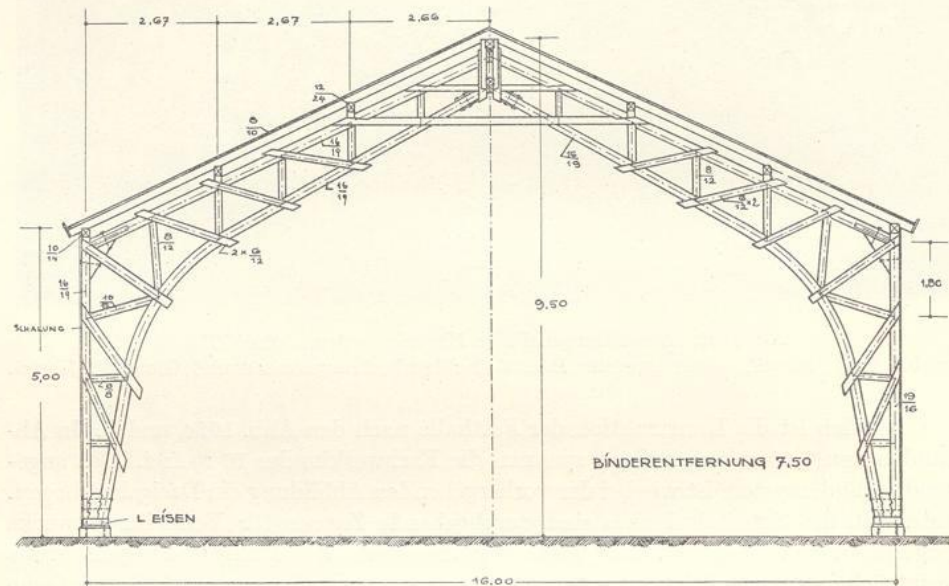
Binder für die Festhalle anlässlich der Tausendjahrfeier der Stadt Nordhausen. Bearbeitet: T. K., ausgeführt: Zimmermeister B. d. Z. Oskar Beck, Nordhausen.
